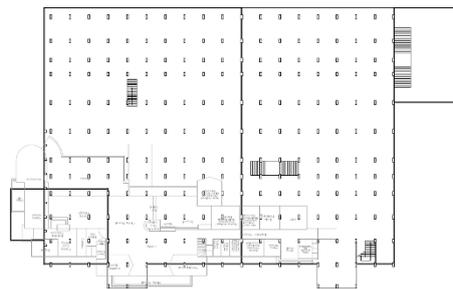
Denah Bangunan Jaman Hindia Belanda
